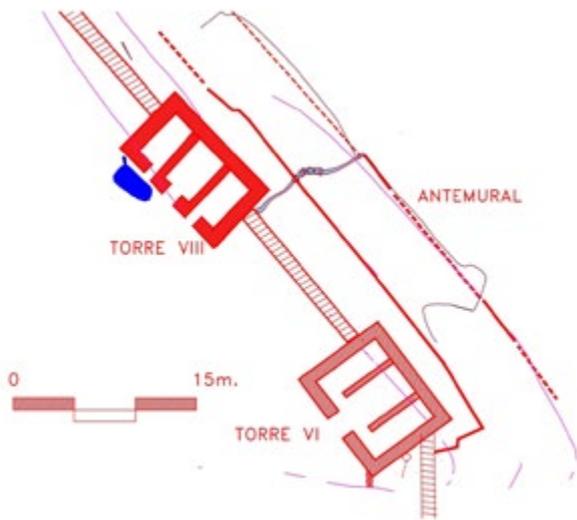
Las torres VI y VIII compartimentadas en tres estancias en la planta inferior.
